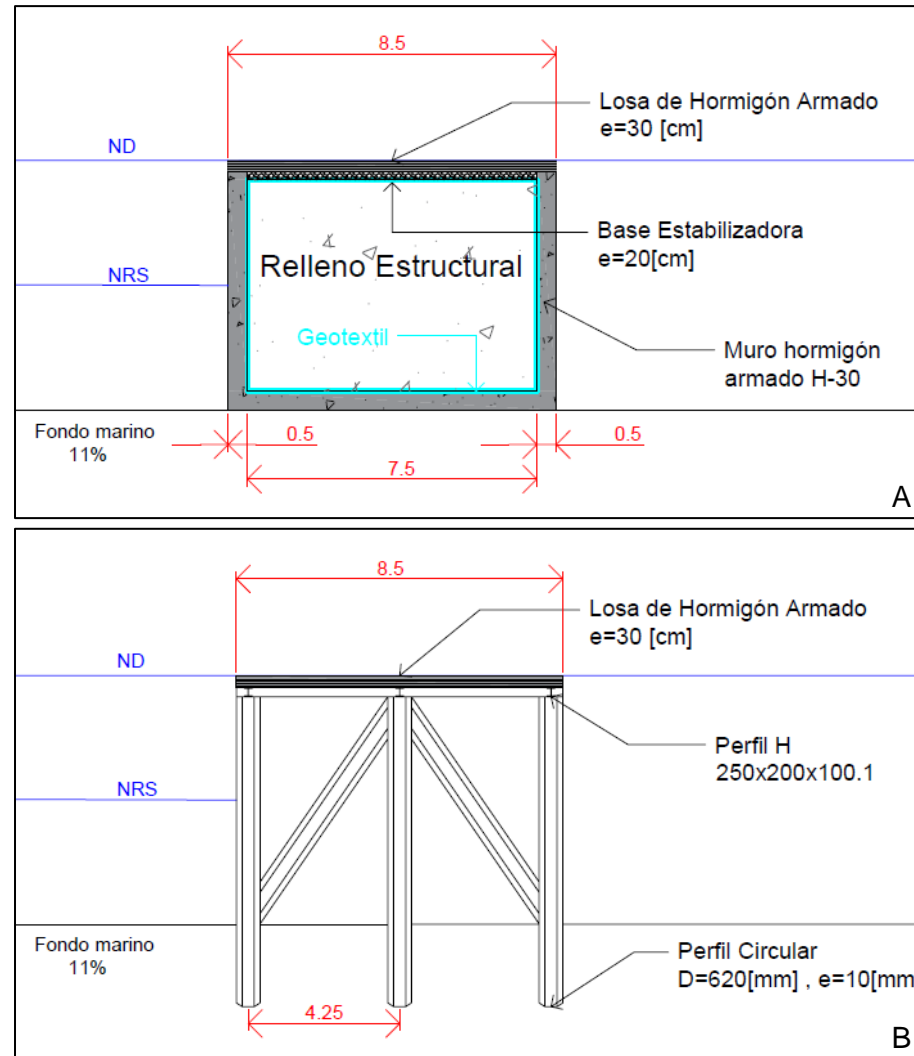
Plano frente rampa A) Opaca y B) Transparente. Fuente: Elaboración propia con Autocad.
